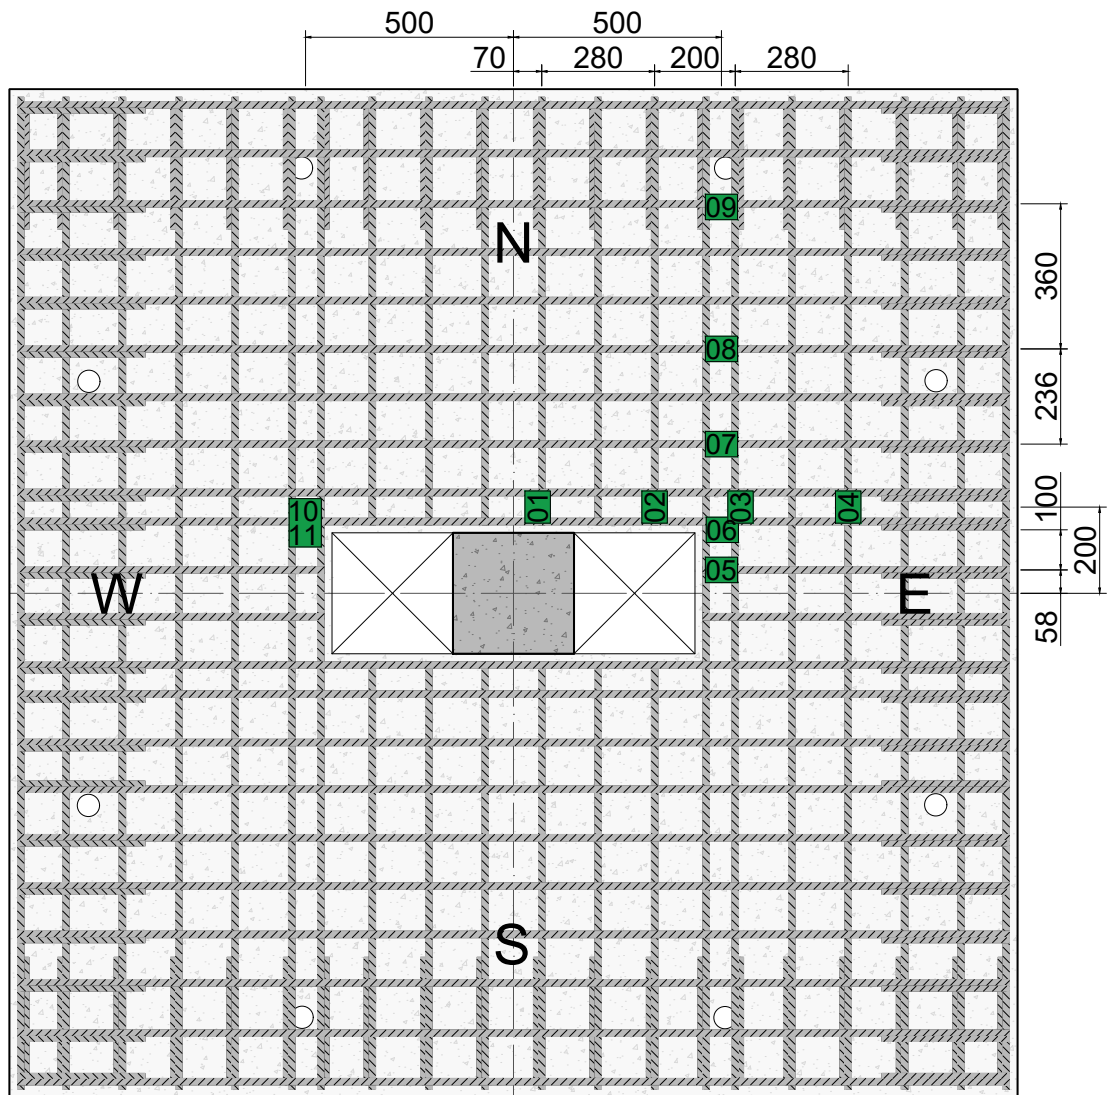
Posicionamento dos extensômetros nas barras de flexão das lajes LRFS e LFE1 [mm]
